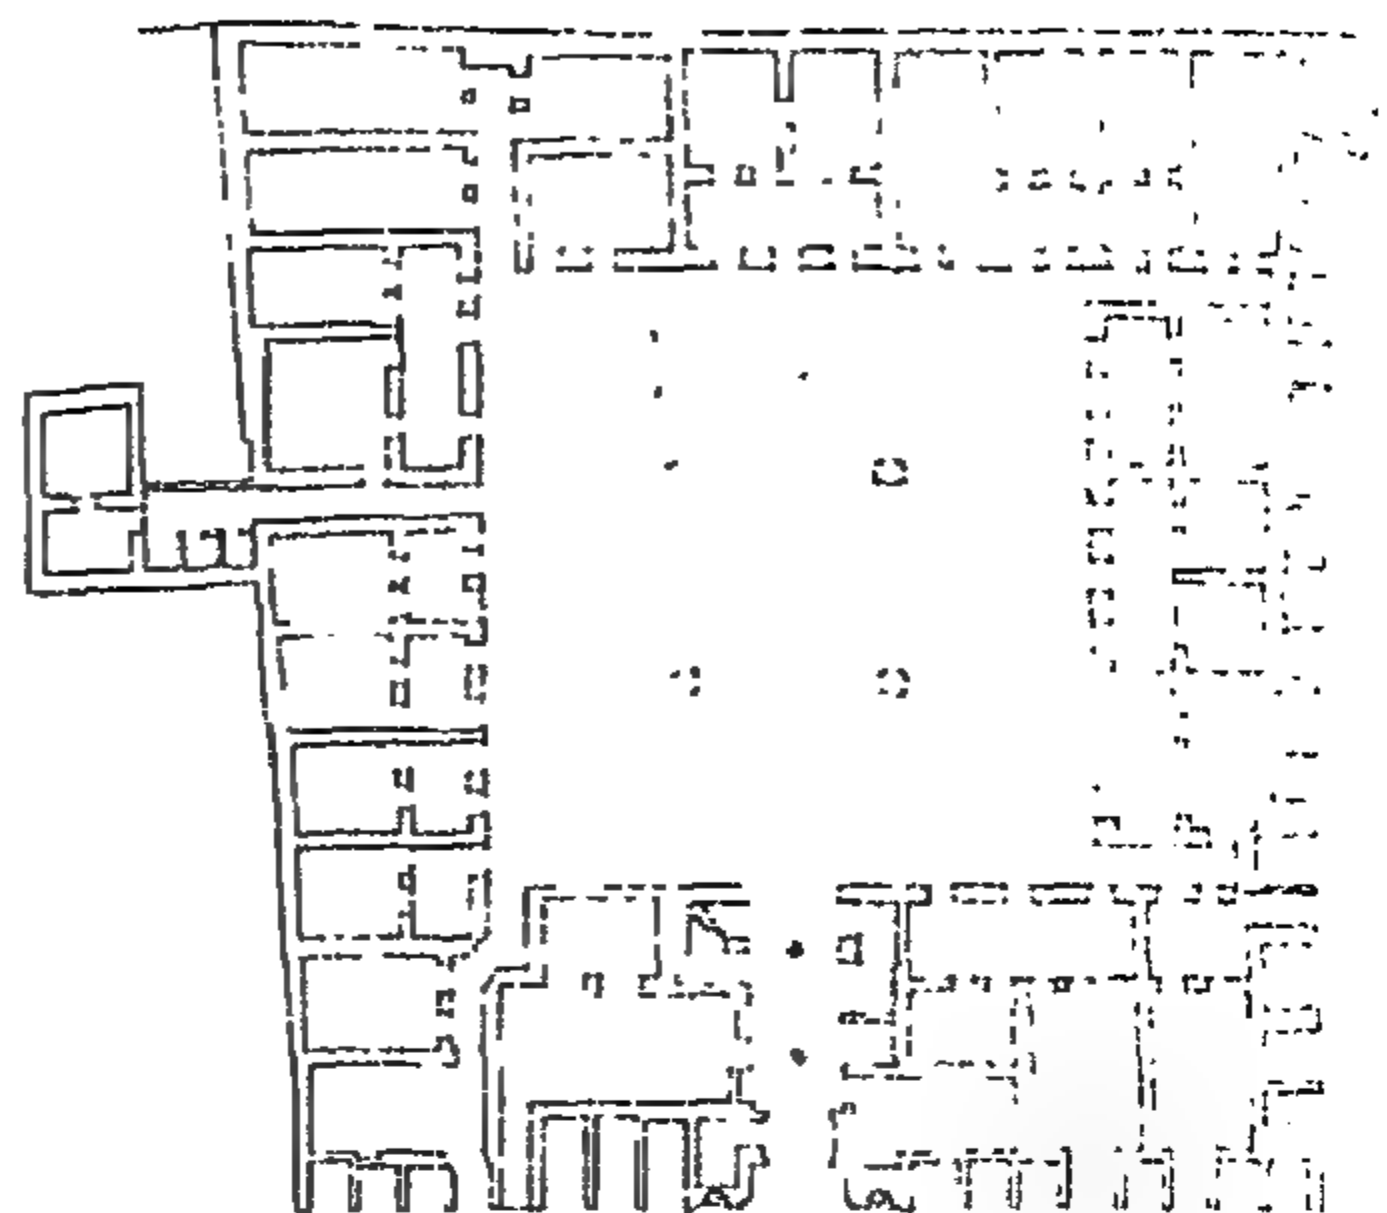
مسقط أفقي للخان بقصر الحير الغربي . (عن : كريزول) .
